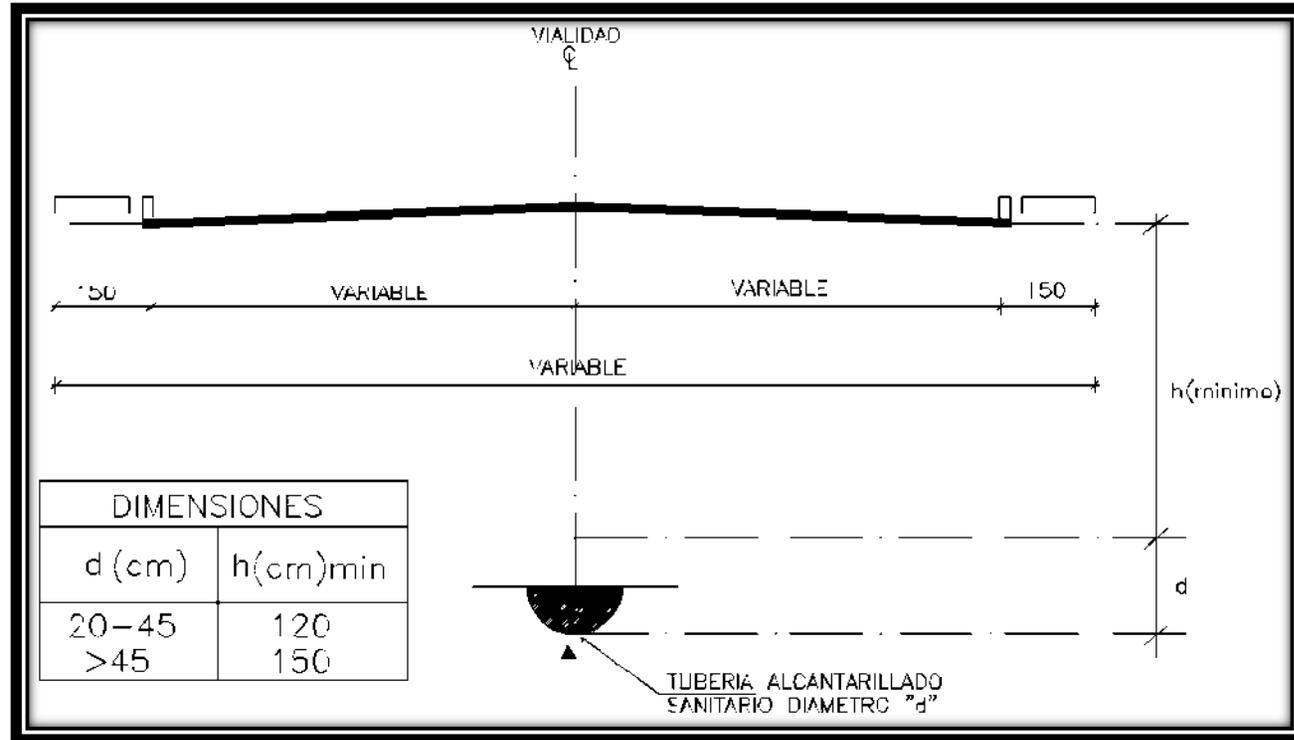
Instalación de Tuberías de Drenaje sanitario en zanjas<sup>88</sup>
